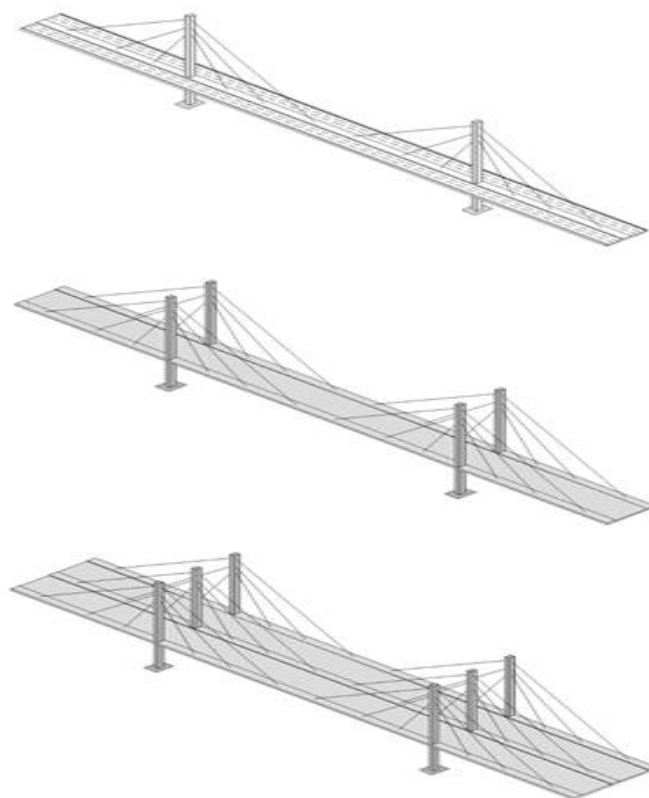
Configurações transversais dos cabos, um plano de suspensão, dois planos de suspensão e três planos de suspensão [3]
